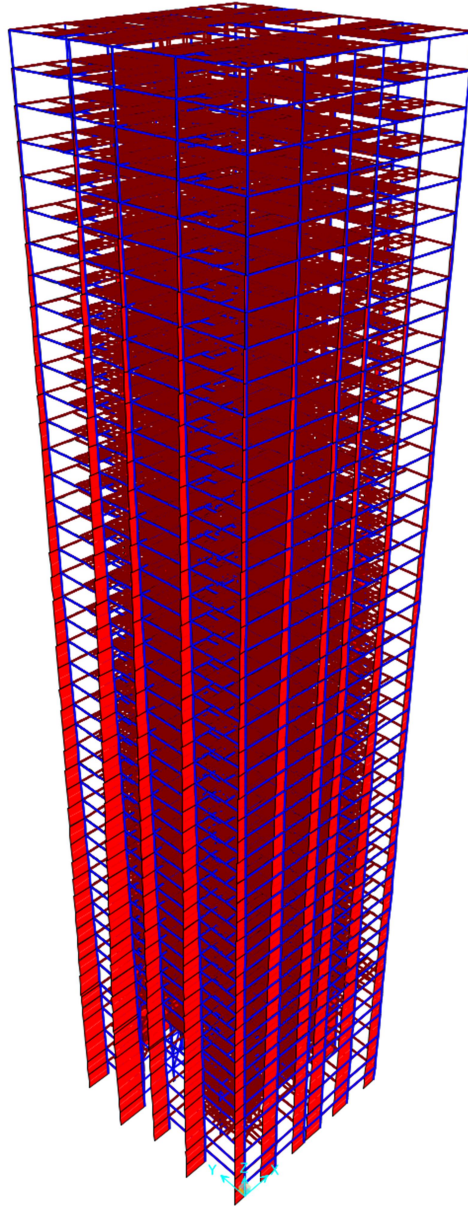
1 Pemodelan Struktur Bangunan SAP2000
